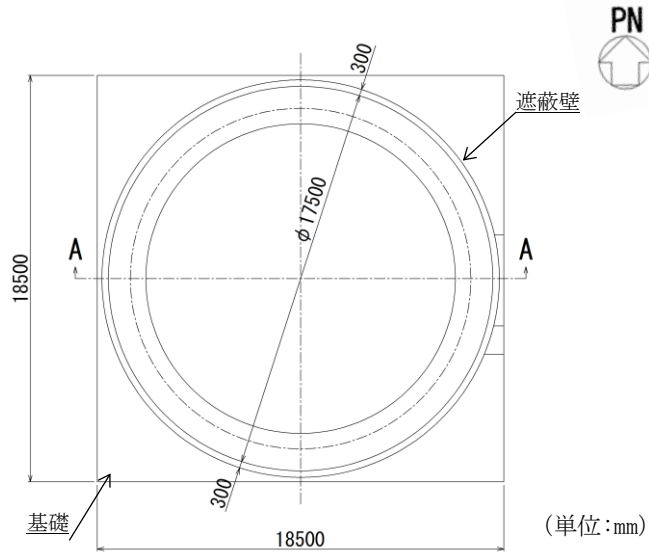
トーラス水受入タンク遮蔽壁 平面図
